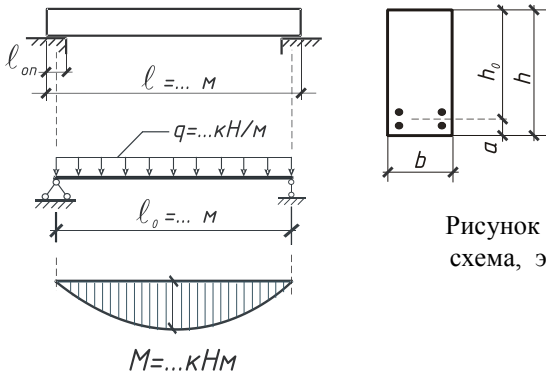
Схема опирания, расчетная схема, эпюра M и сечение балки БЖС
